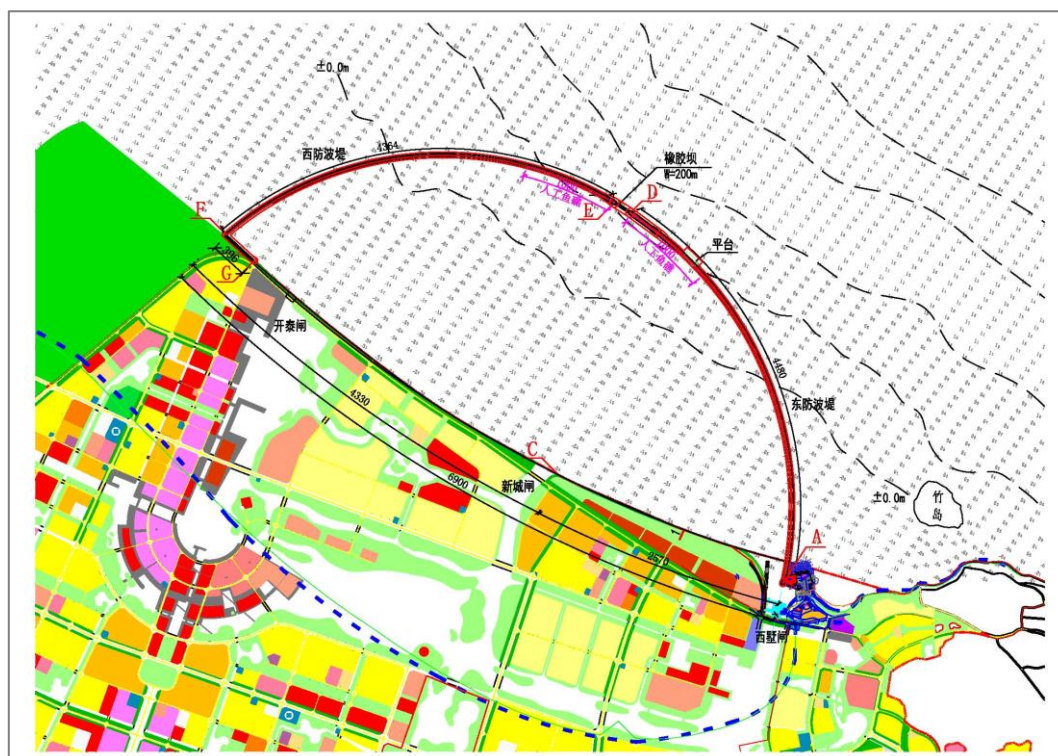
连云港市连云新城蓝色海湾基础工程总平面布置图
